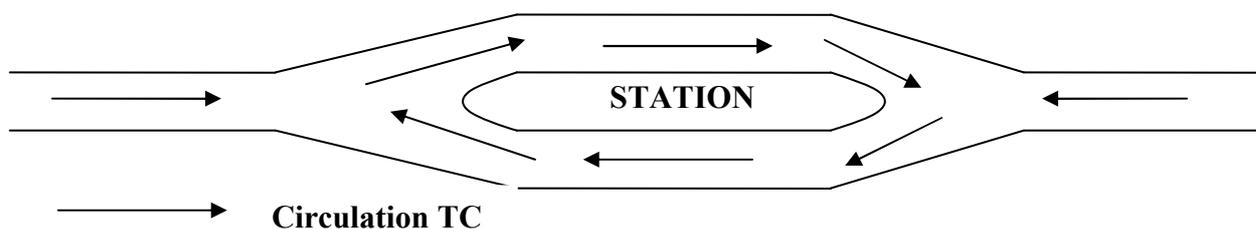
Schéma de principe d'un site propre avec croisement en station
